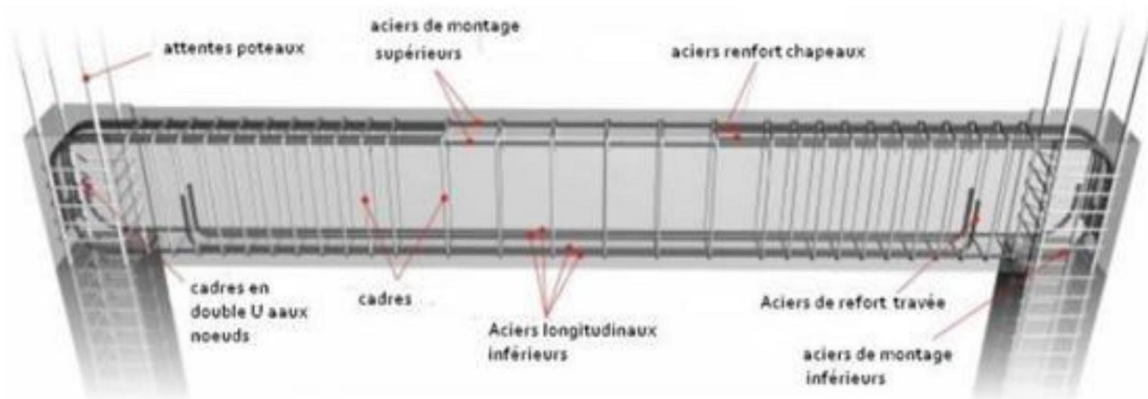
Disposition du ferrailage dans une poutre en béton armé
